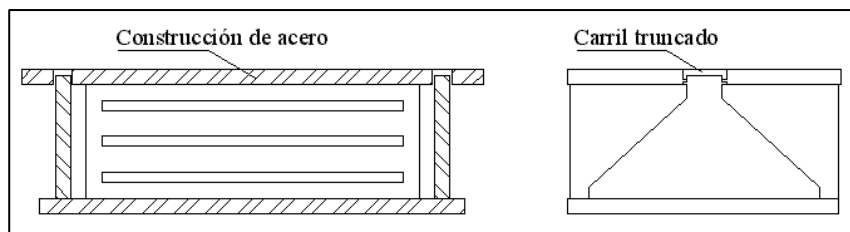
Apoyo de elastómero con construcción de acero fijo en dos direcciones.
